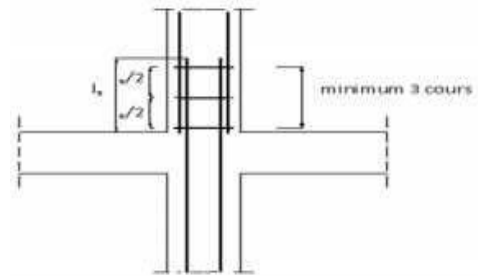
Les armatures transversales dans la zone de recouvrement.
